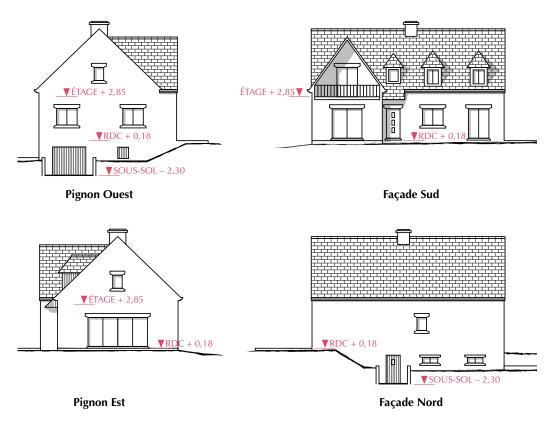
Plans pignons (à gauche) et façades (à droite) © Alain Béthune
